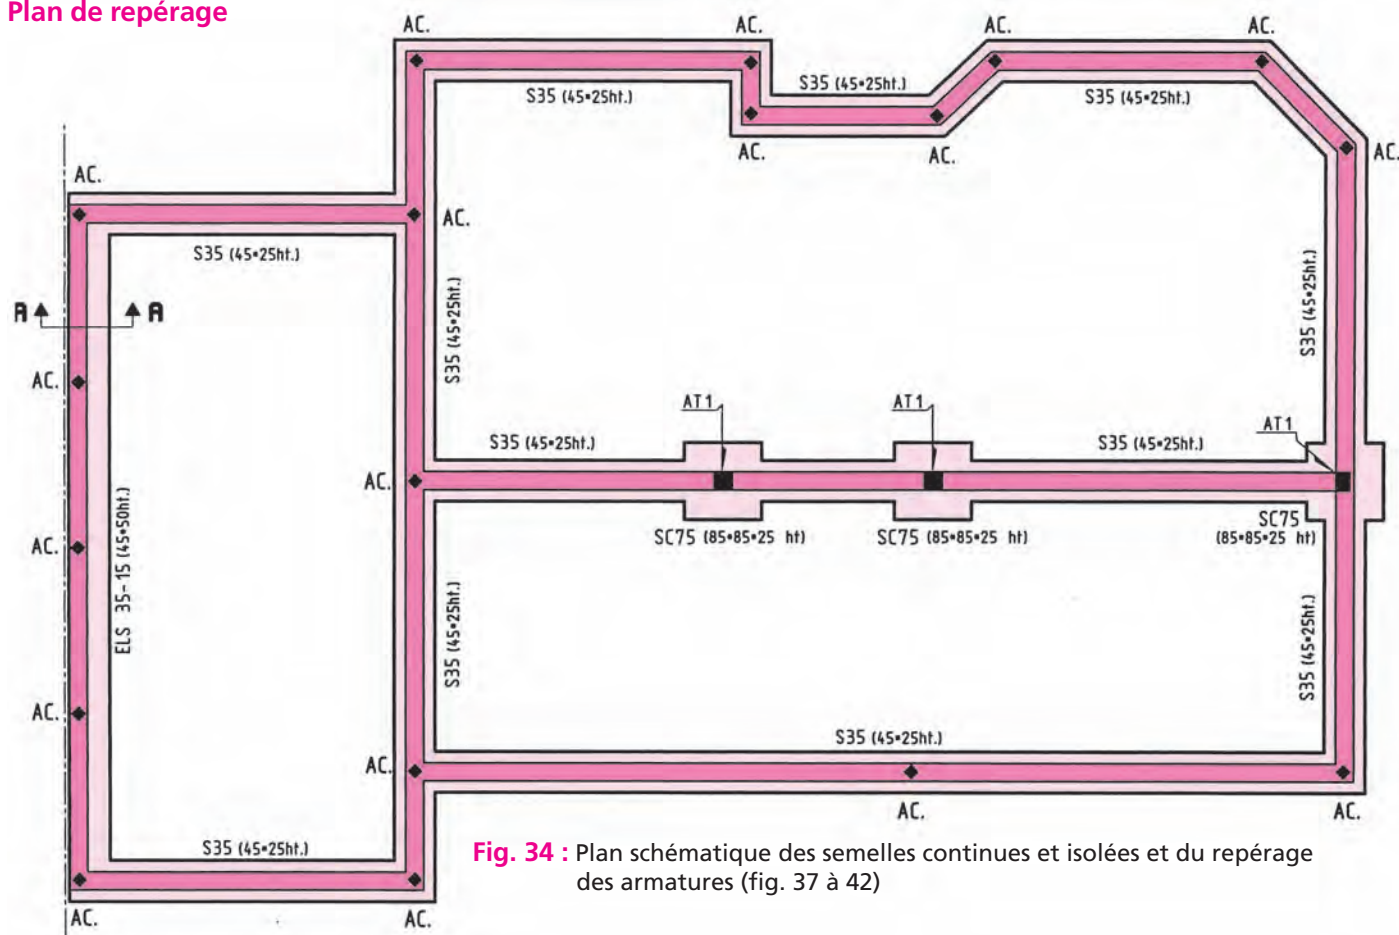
Plan schématique des semelles continues et isolées et du repérage des armatures (fig. 37 à 42)
